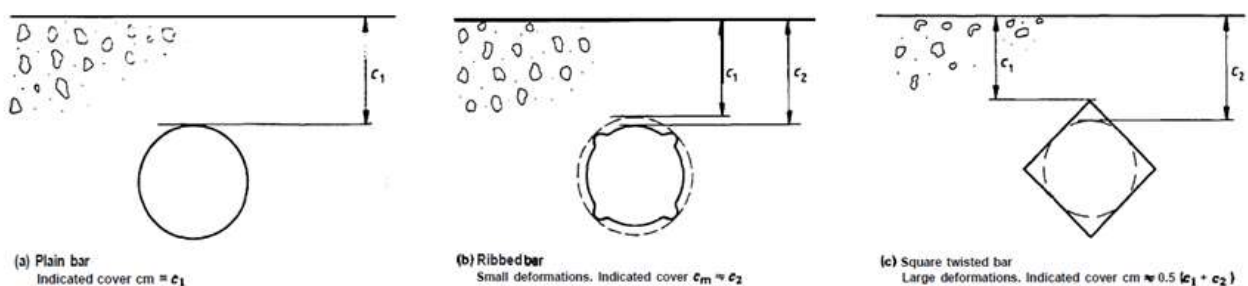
Possibili errori di misura nel caso di barre con sezione trasversale diversa da un cerchio.
